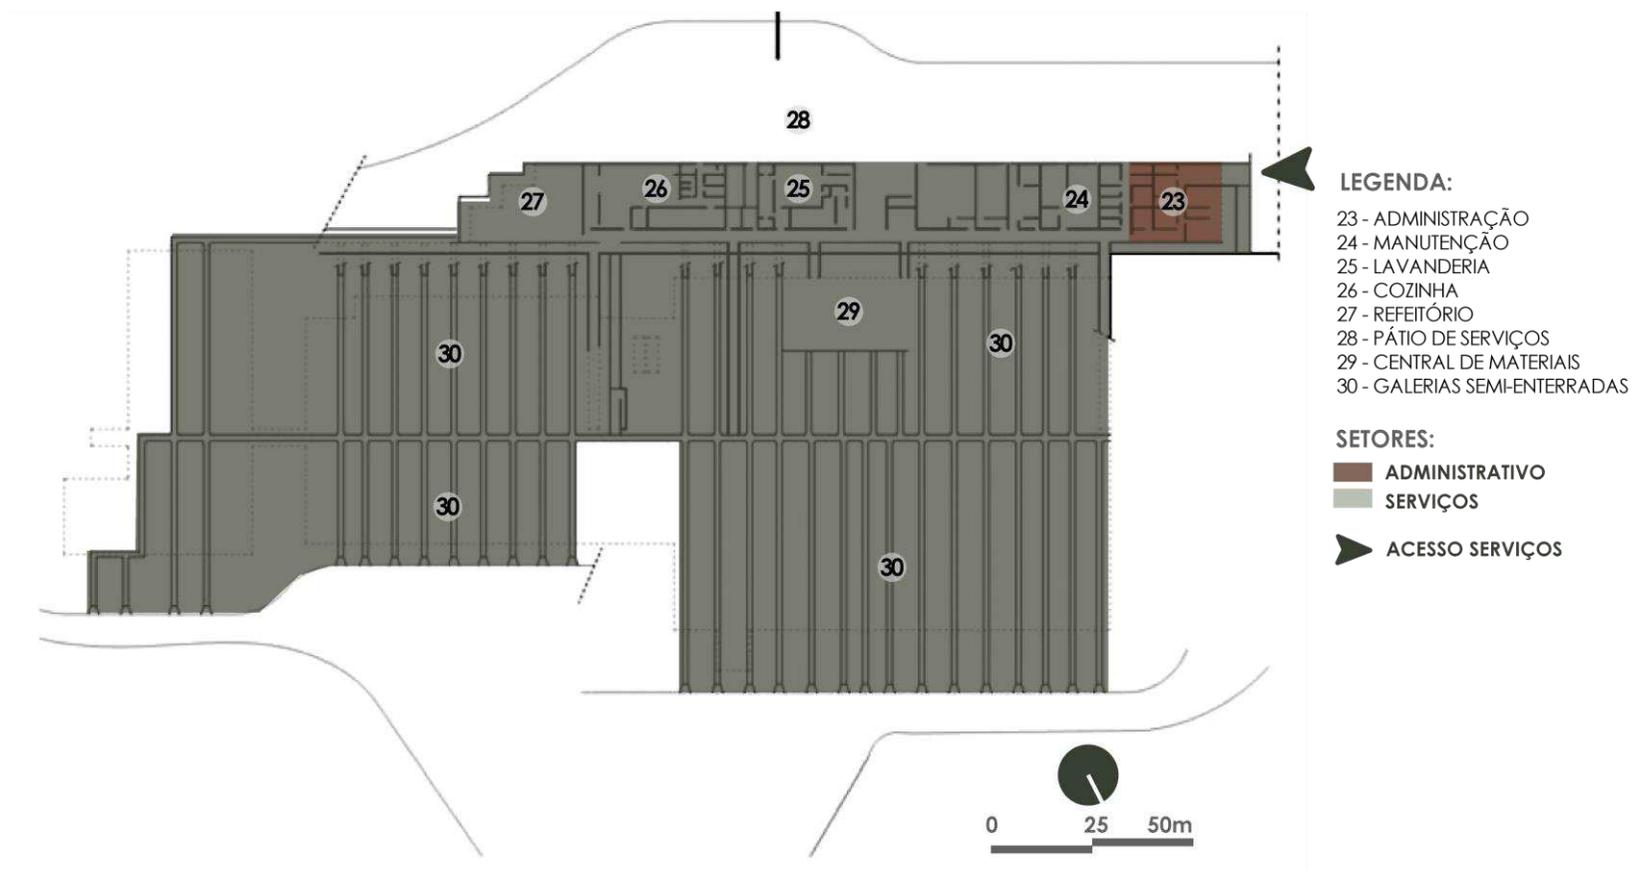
Planta baixa zoneada - Pavimento técnico
